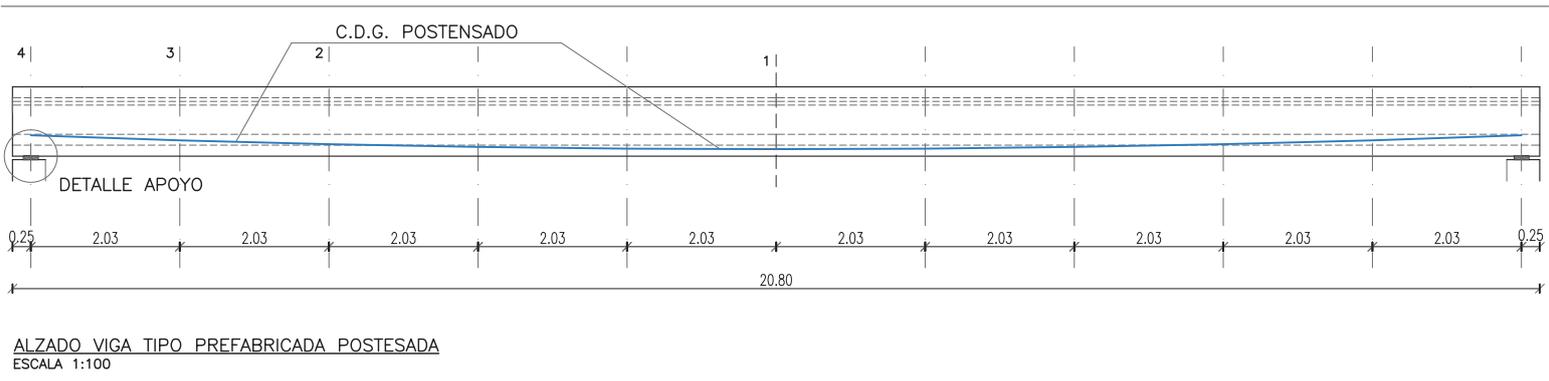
Alzado de vigueta tipo prefabricada postesada. Escala 1:100 [27]
